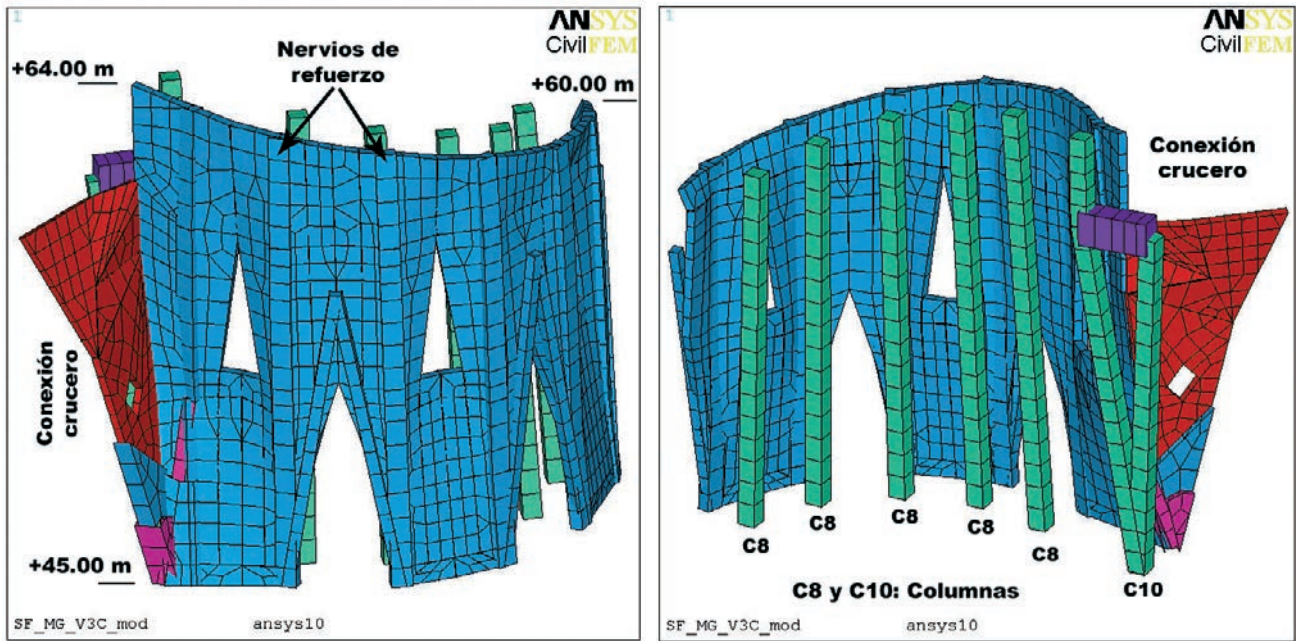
Muro y columnas del ábside (media sección): a) vista exterior y b) vista interior
